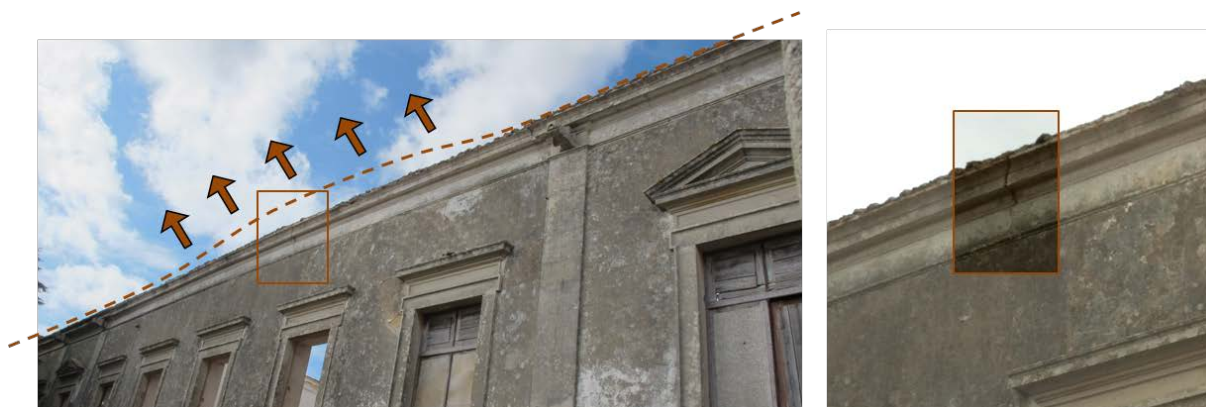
O abaulamento de secções da Fachada Sul está a provocar fissuras na cornija.
